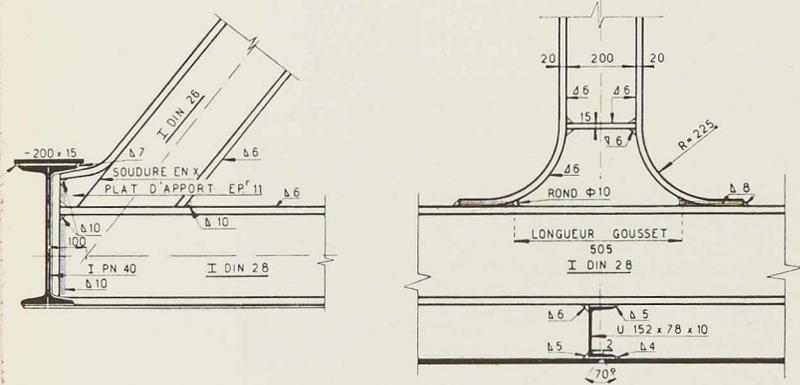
Schéma de la poutre Vierendeel soudée de la vanne Stoney.
